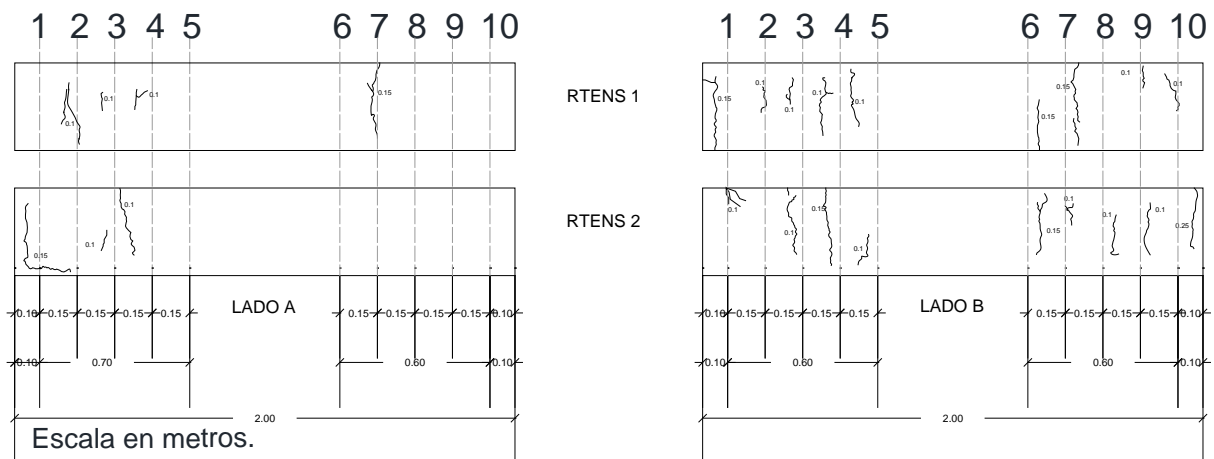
Patrón de agrietamiento por corrosión de las vigas RTENS. Los valores sobre las vigas representan el ancho de grieta (mm) y las acotaciones (m).
